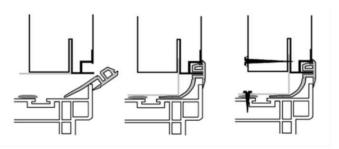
Joint d'étanchéité J8 et cornière PVC
